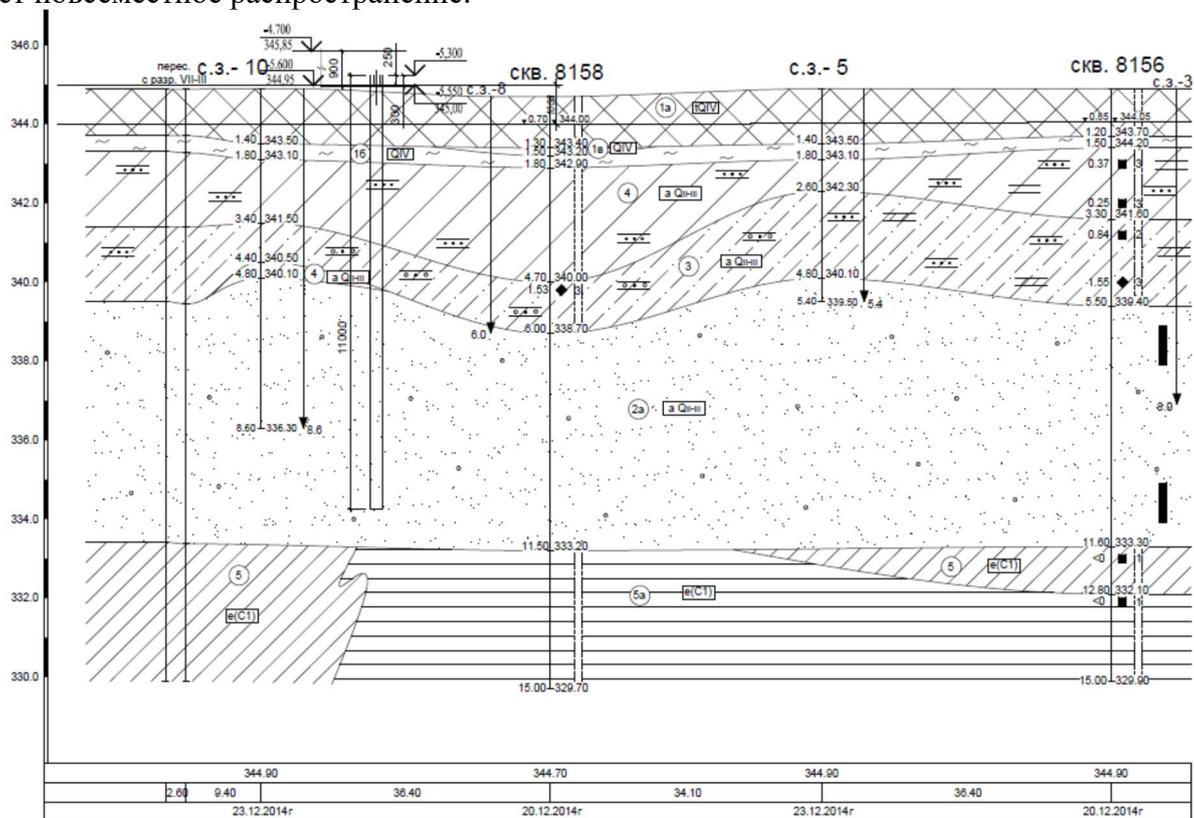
Инженерно-геологический разрез с посадкой фундамента блока 1
